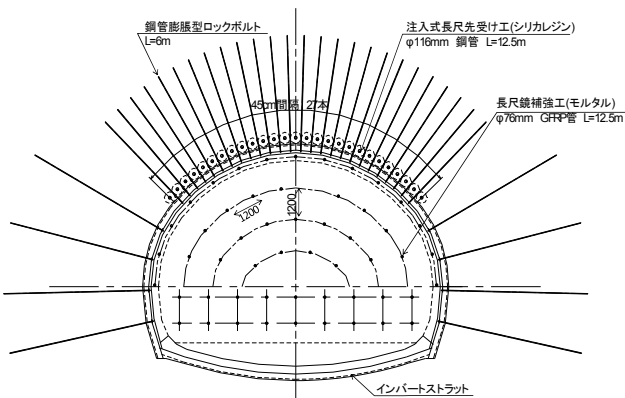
追加地山補強工を採用した施工パターン図(横断面図)
